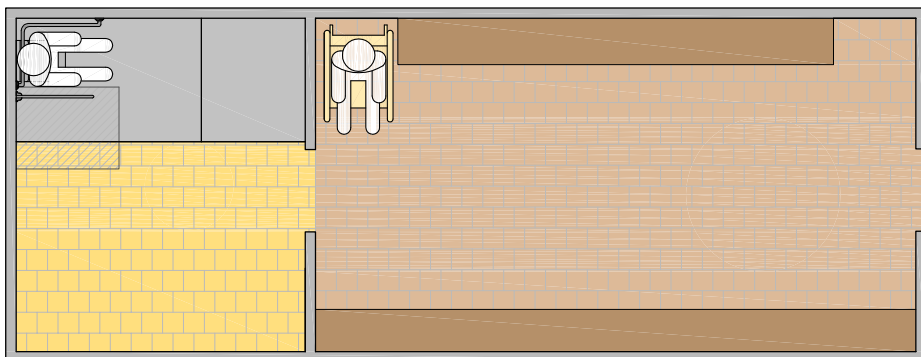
Vista en planta de un vestuario accesible con ducha y probador.
